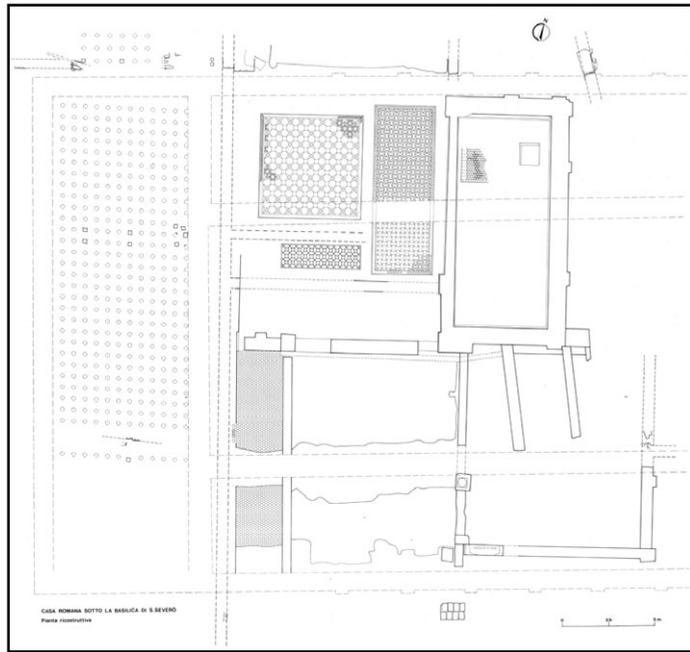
Planimetria della villa individuata al di sotto della basilica di San Severo
